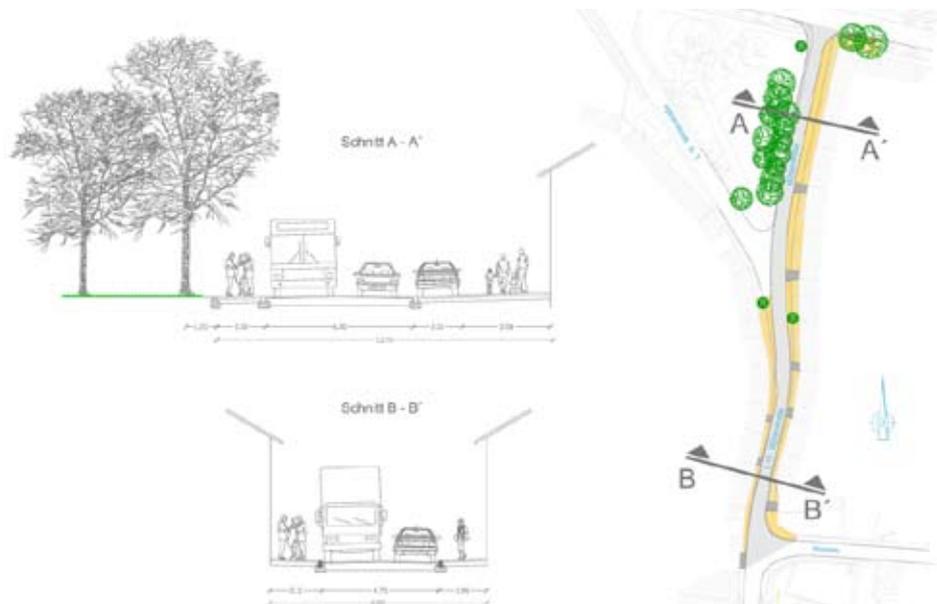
Variante 2: Mühlenstraße mit Engstelle, Schnitt , M 1:250 im Original
